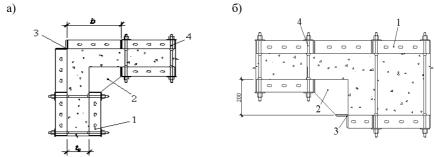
Схема устройства опалубки участков стены: а- прямых углов стен; 6 - участка стены ступенчатого очертания; 1 — щит; 2 — внутренний угол; 3 — наружный угол; 4 — винтовой тяж
